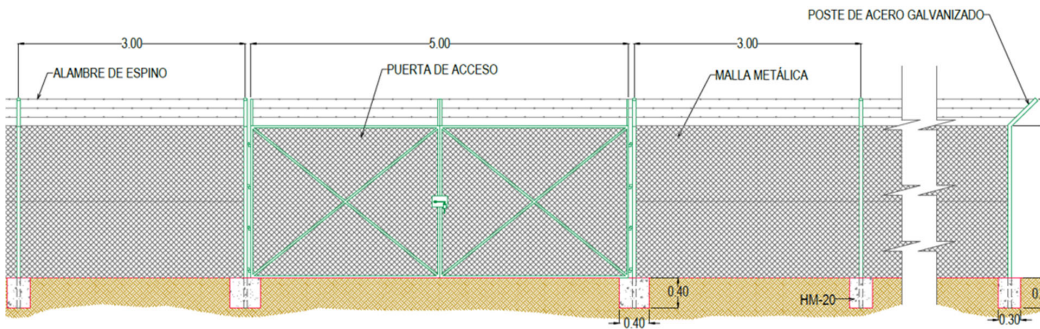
Detalle de características del vallado perimetral de la balsa de la finca La Zarza.
